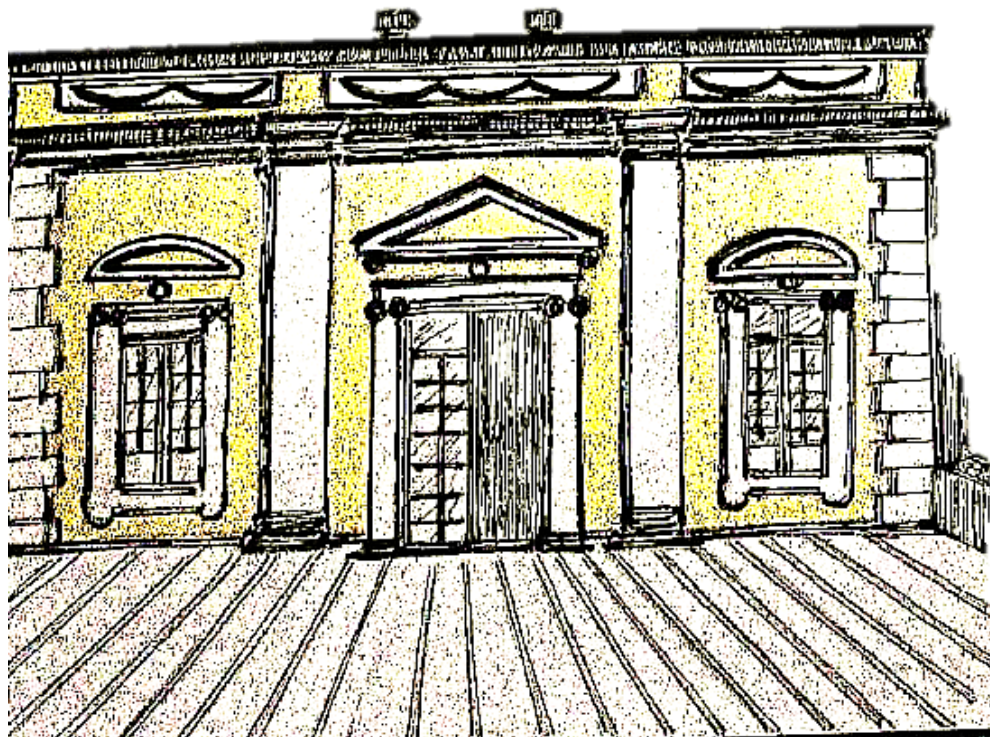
Dibujos a mano. Fuente. Propia ilustración Plantas de la estación ferroviaria y corte proyectual
